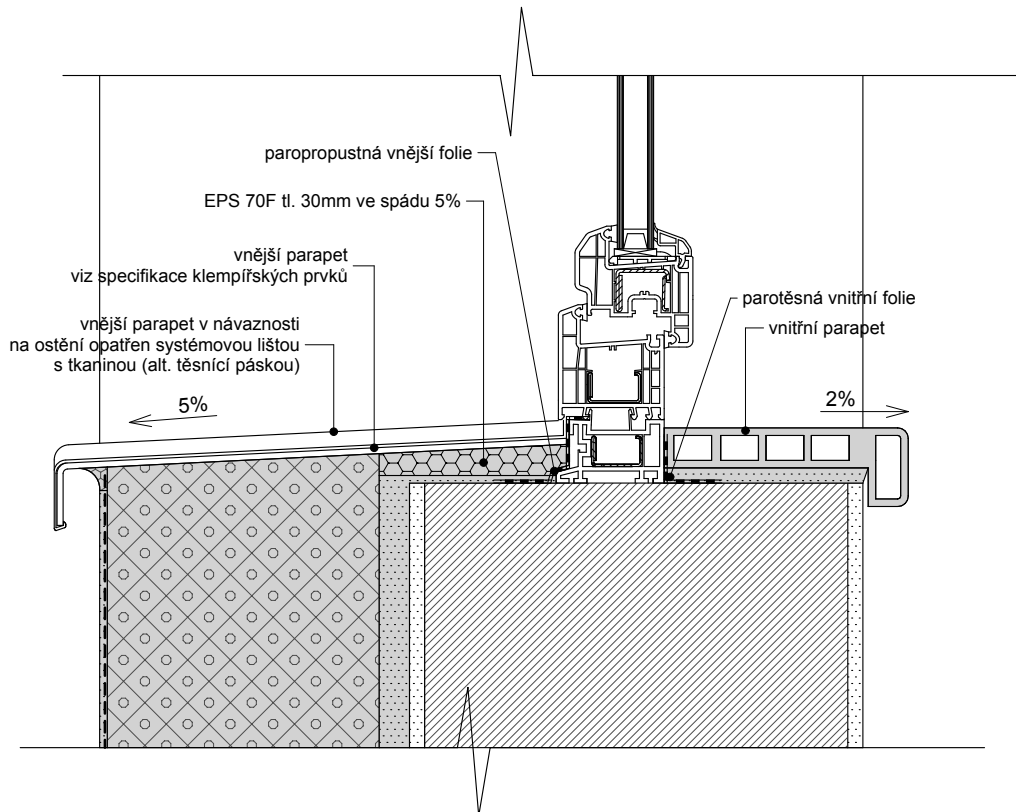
PARAPET TYPICKÉHO OKNA V PŘÍSTAVBĚ, M=1:10
